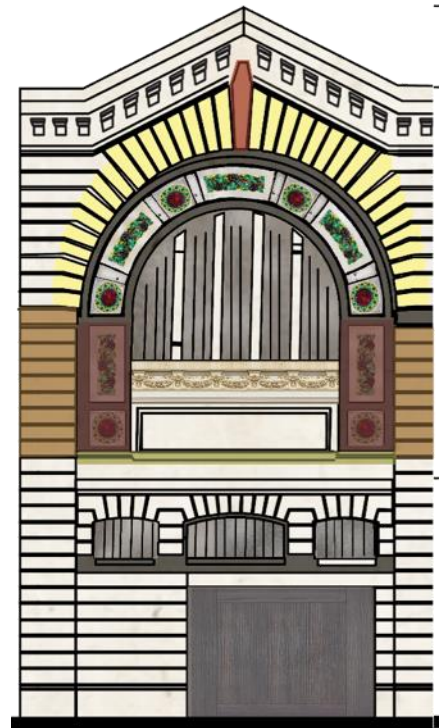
vaisseau la façade secondaire Sud-Ouest,
